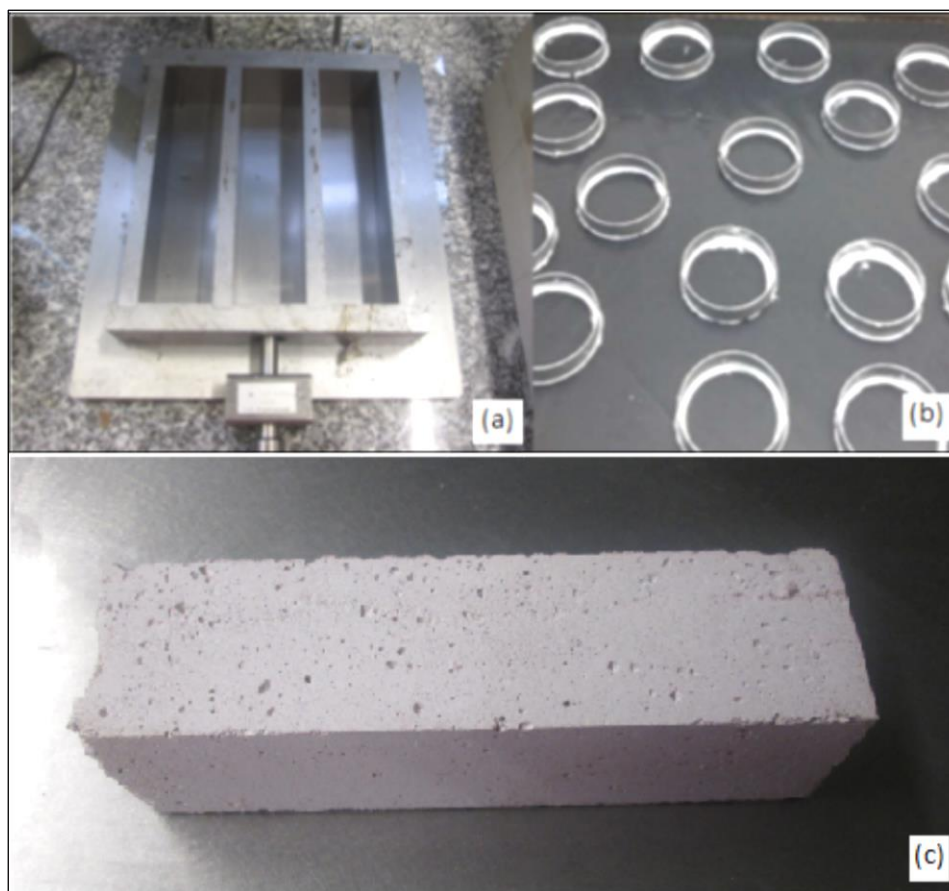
Moldagem dos provetes Prismáticos (a); moldagem dos provetes cilíndricos (b); Provede prismático (c).
